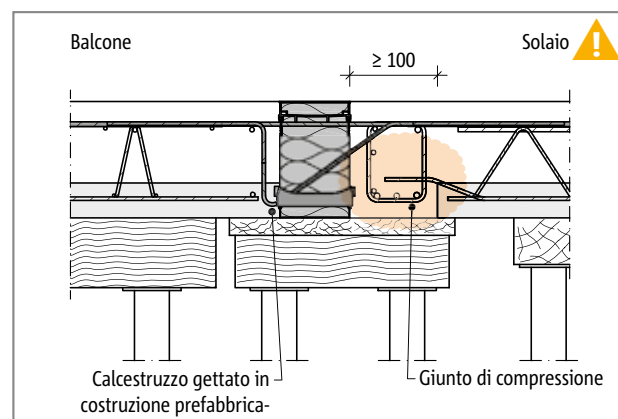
Schöck Isokorb® tipo KXT: appoggio indiretto, montaggio con piastre prefabbricate (qui: $h \leq 200$ mm), giunto di compressione lato solaio
